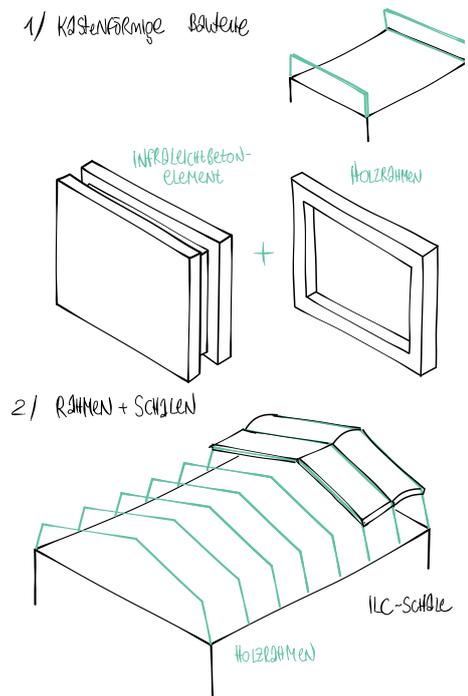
Zwei denkbare Ansätze mit Infraleichtbeton
